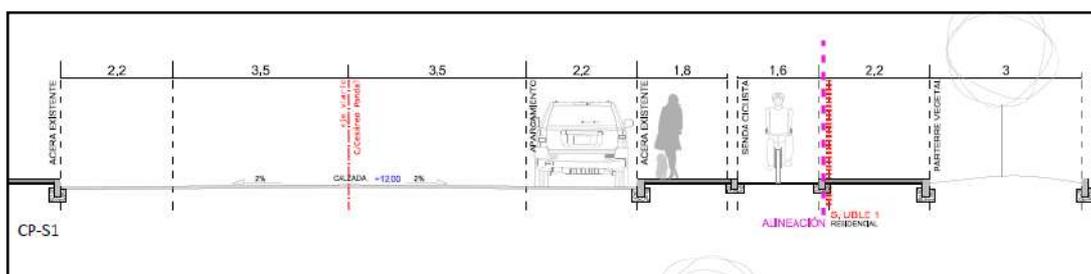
Perfil transversal proyectado para la calle Cesáreo Pondal.
